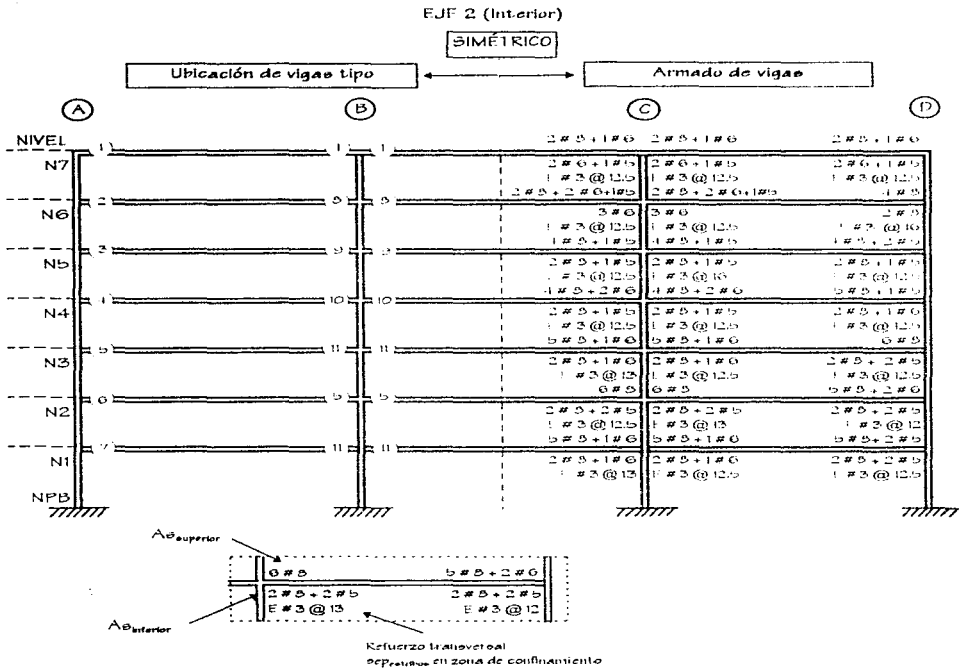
Ubicación de tipos de armados de las vigas del eje 2 de la estructura diseñada en la zona III
